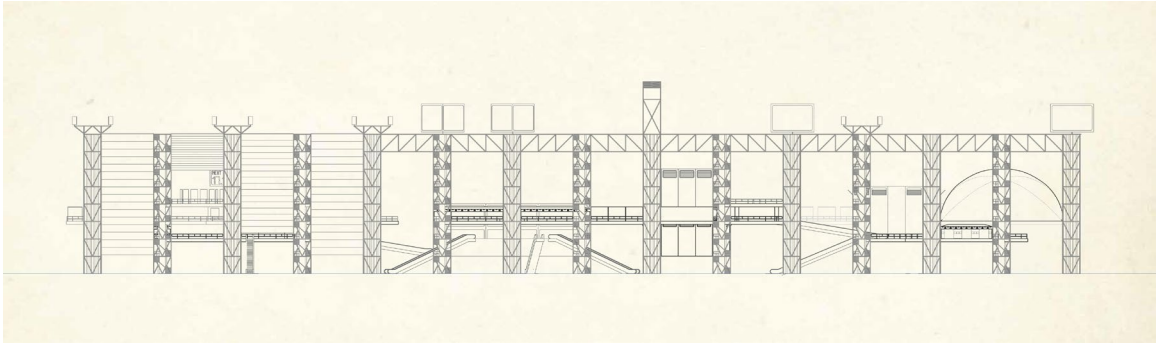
Una posible configuración del Fun Palace, alzado. Elaboración propia
